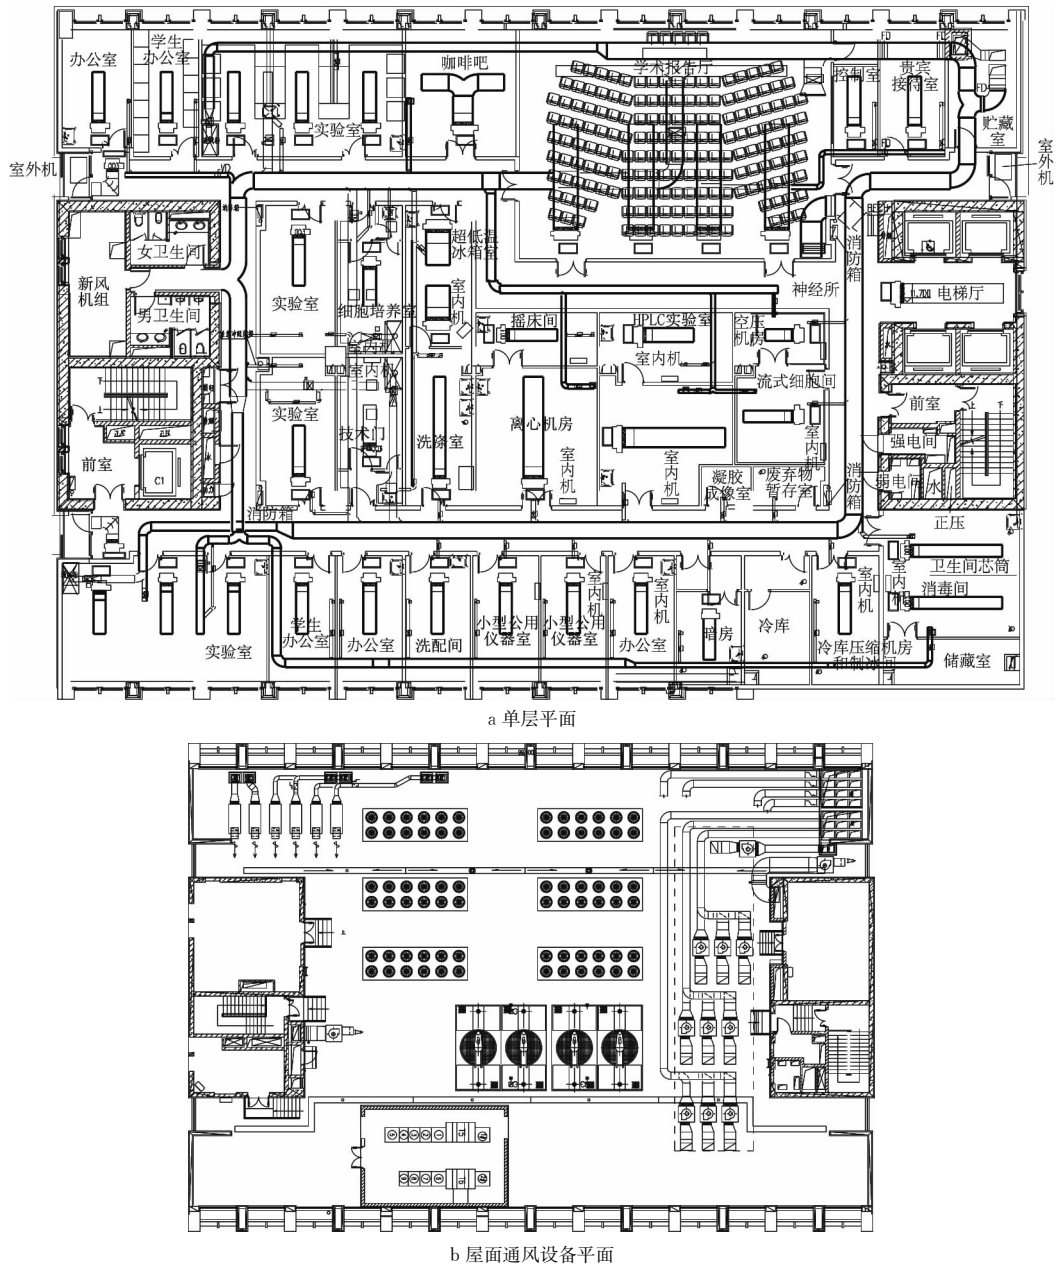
14 层实验大楼单层平面和屋面通风设备布置图
